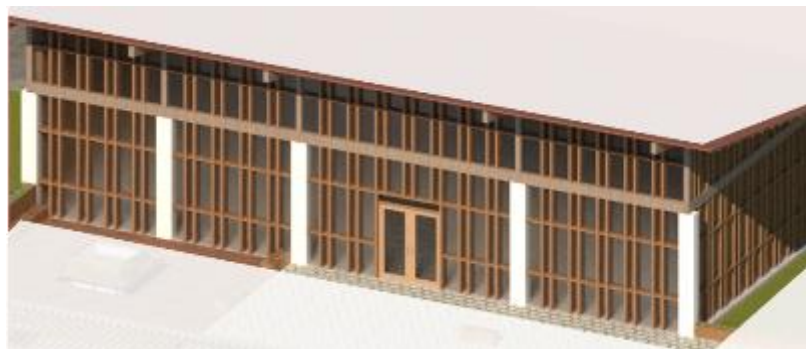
Fachada de bloques de doble altura al interior del conjunto. Fuente: elaboración propia.
